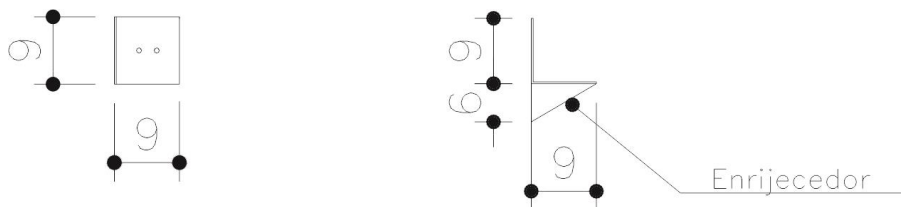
Planta e elevação Ligação expansível de topo.
